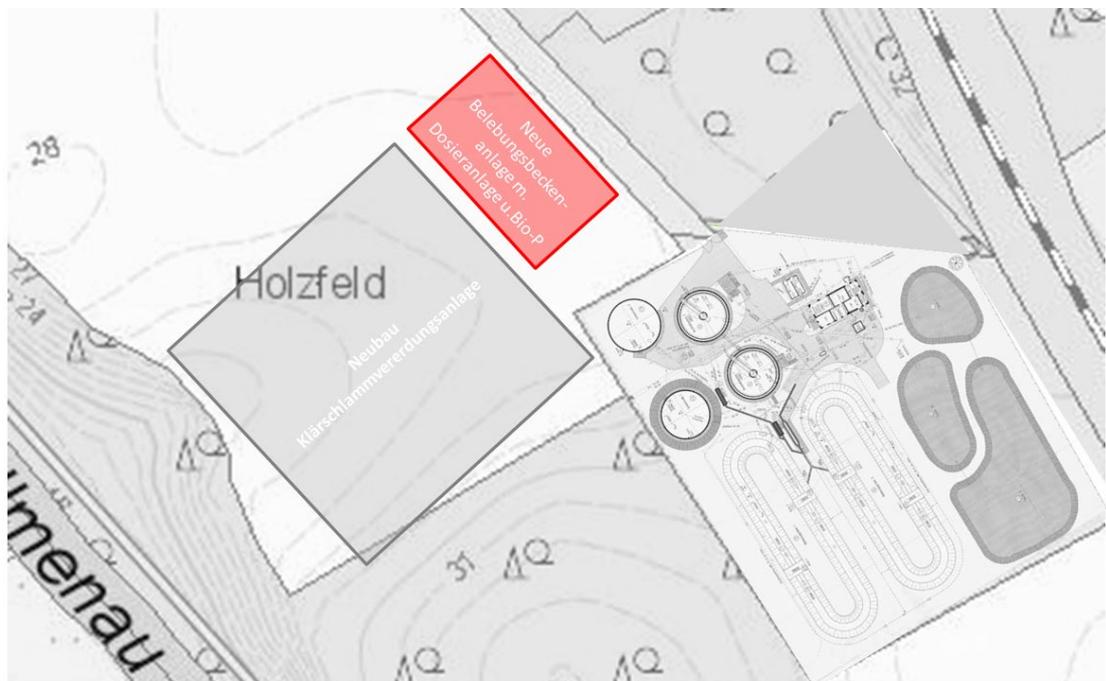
Lageplan der Kläranlage Bienenbüttel mit geplanten Maßnahmen 1
